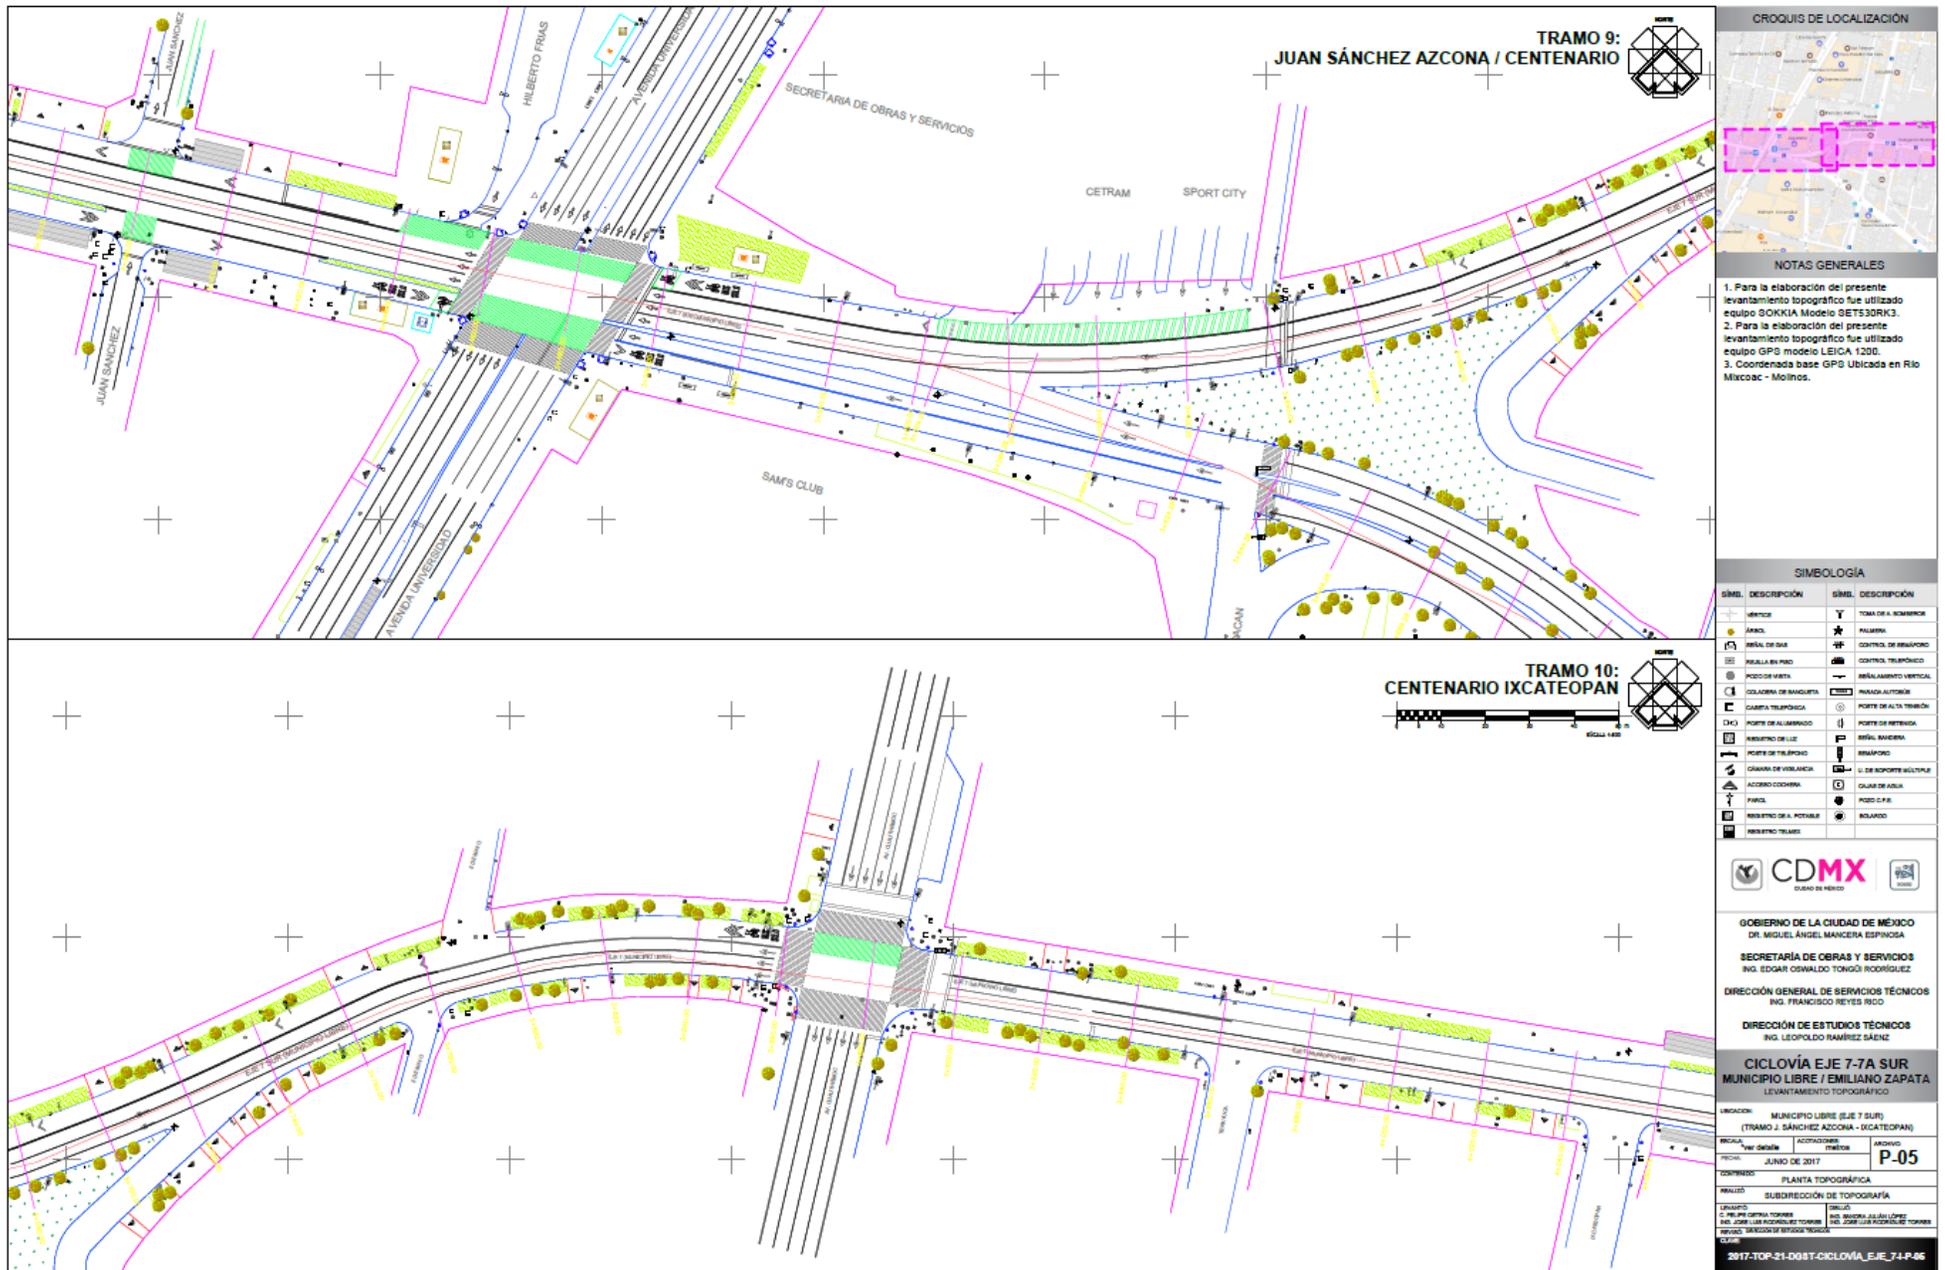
Plano Topográfico eje de proyecto escala 1:500.
